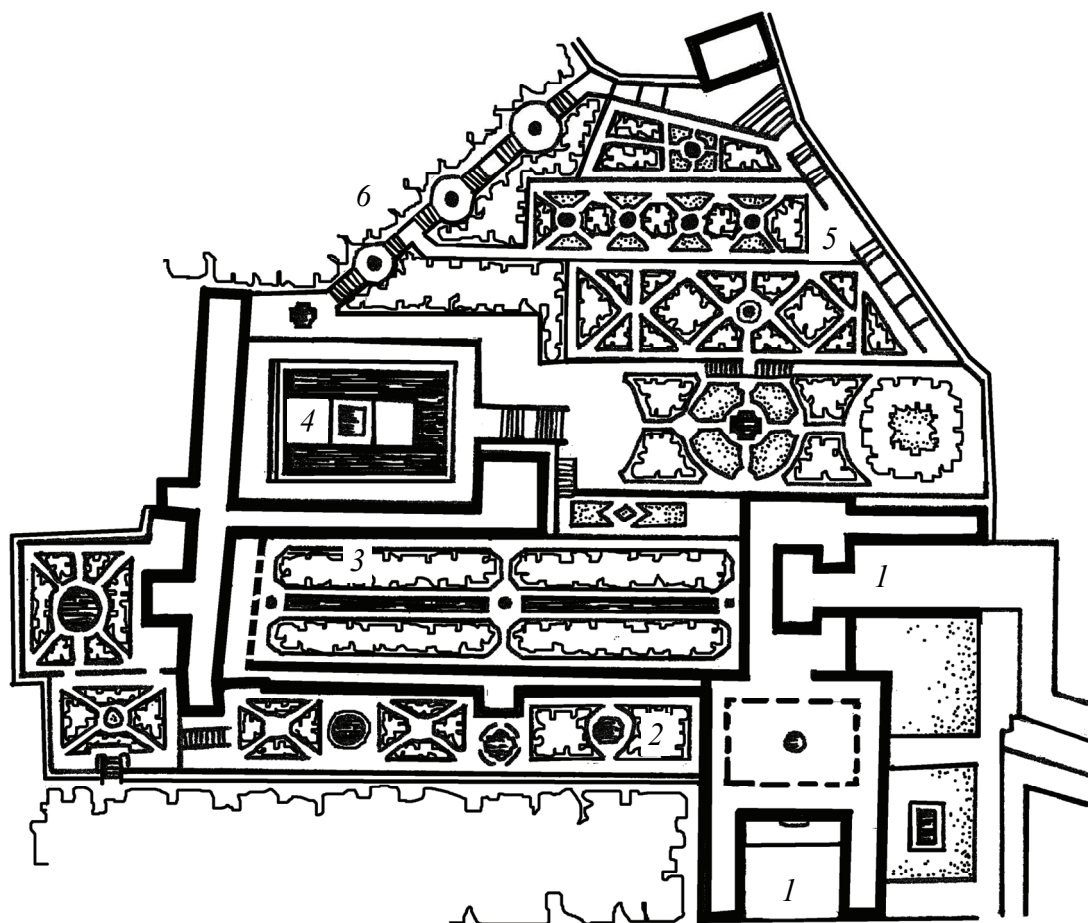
План садов Генералифа (Испания): 1 – входы; 2 – нижняя терраса; 3 – канал; 4 – Сад султанши; 5 – верхние террасы; 6 – каскад
